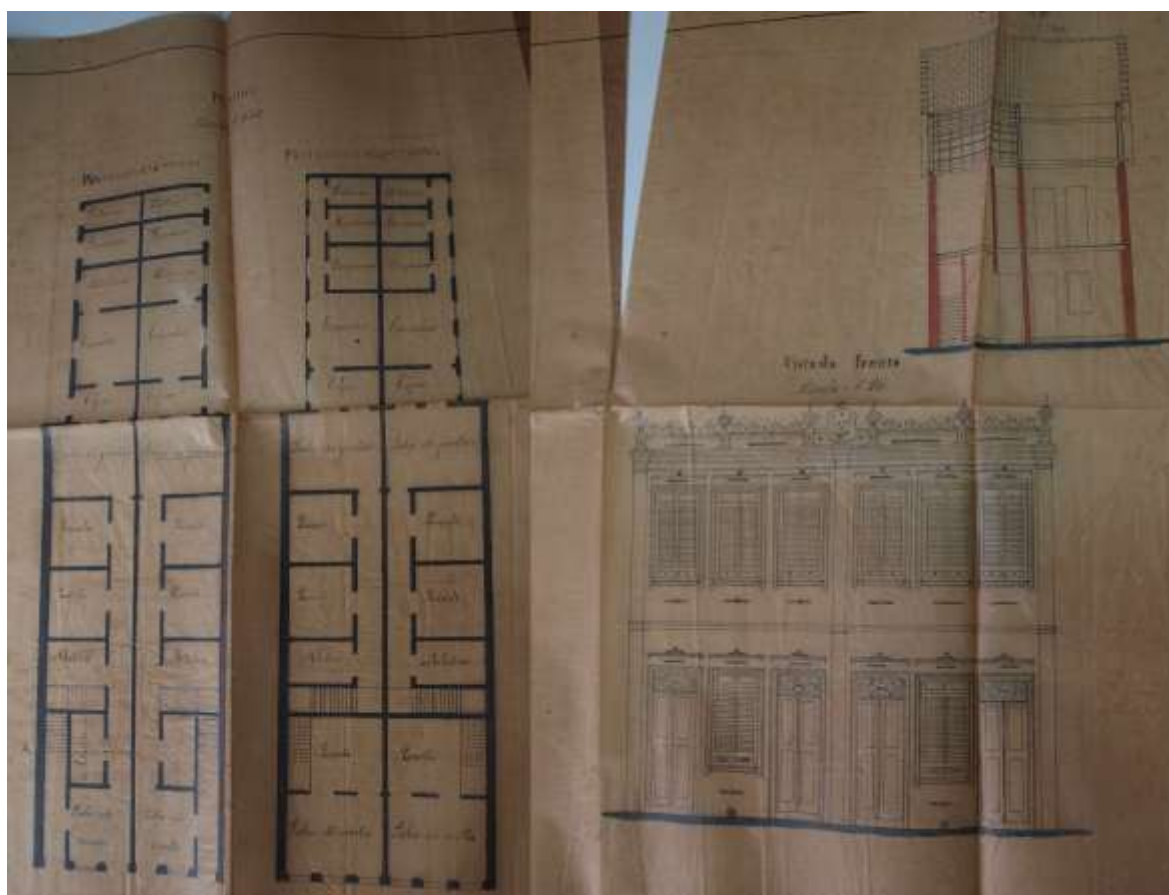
Conjunto anterior a Lei 1146/1926, primeira referência à planta de situação, mostra apenas plantas baixas, corte e fachada. Projeto para o distrito da Vitória apresentado em 1899. Fotografia de peça gráfica em papel do arquivo da Fundação Gregório de Matos, 2011.
